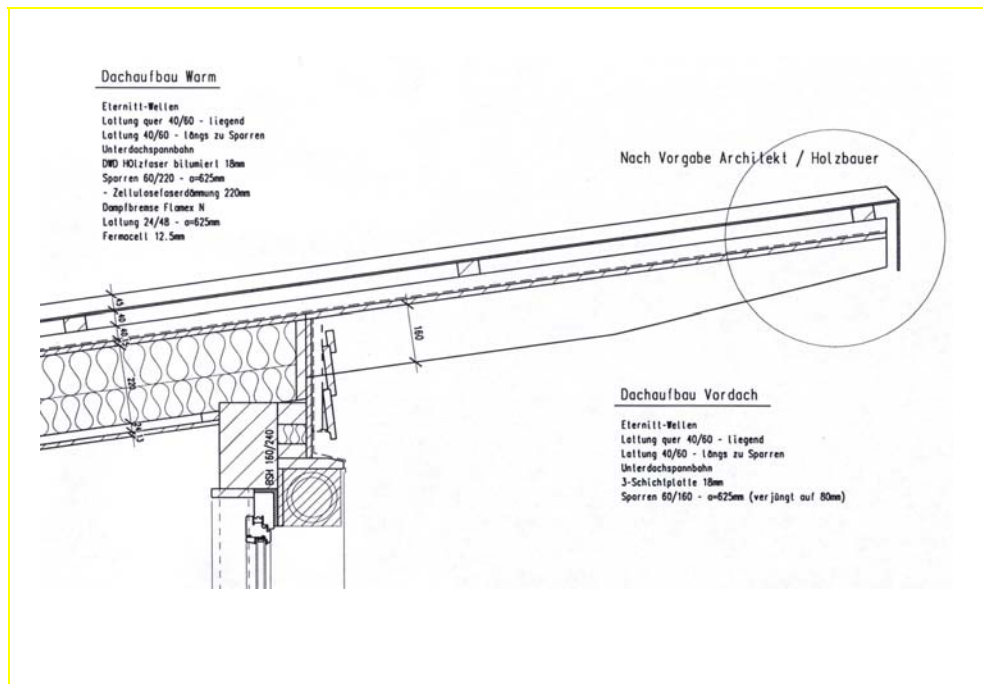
Anschluss Dach an Brettstapelwand
